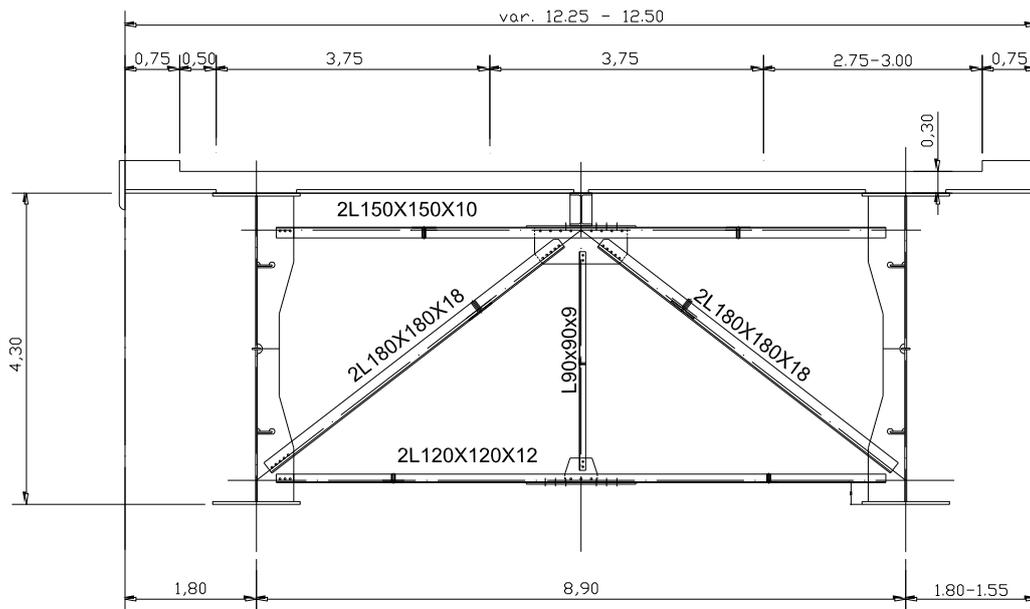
Sezione trasversale dell'impalcato carreggiata destra
